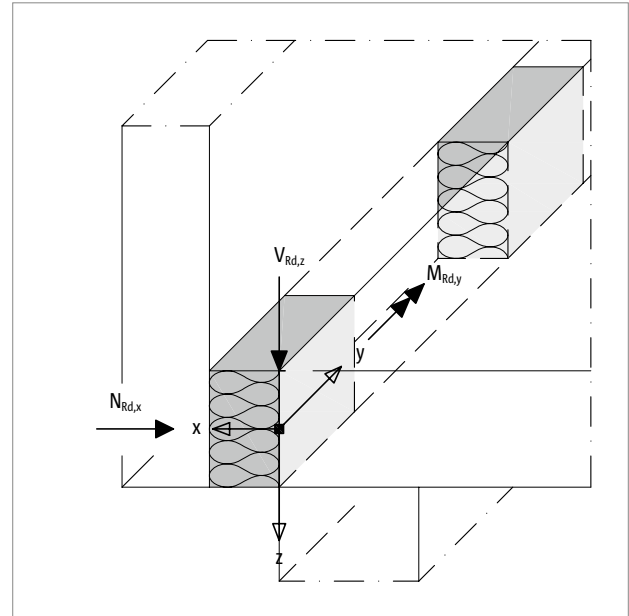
Schöck Isokorb® T Typ AP Vorzeichenregel für die Bemessung von vorgesetzten Brüstungen
